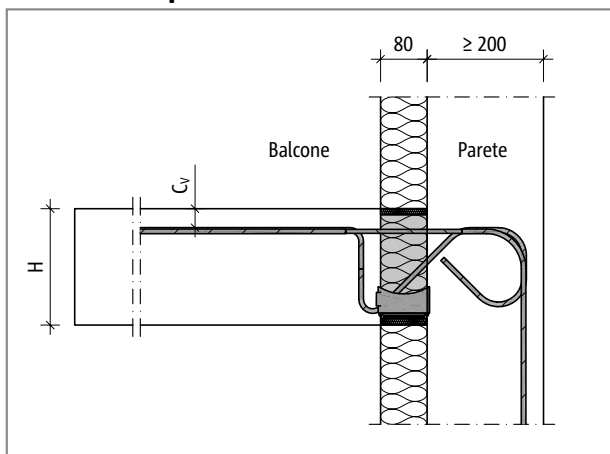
Schöck Isokorb® T tipo KL-WU: raccordo alla parete verso il basso con isolamento esterno
